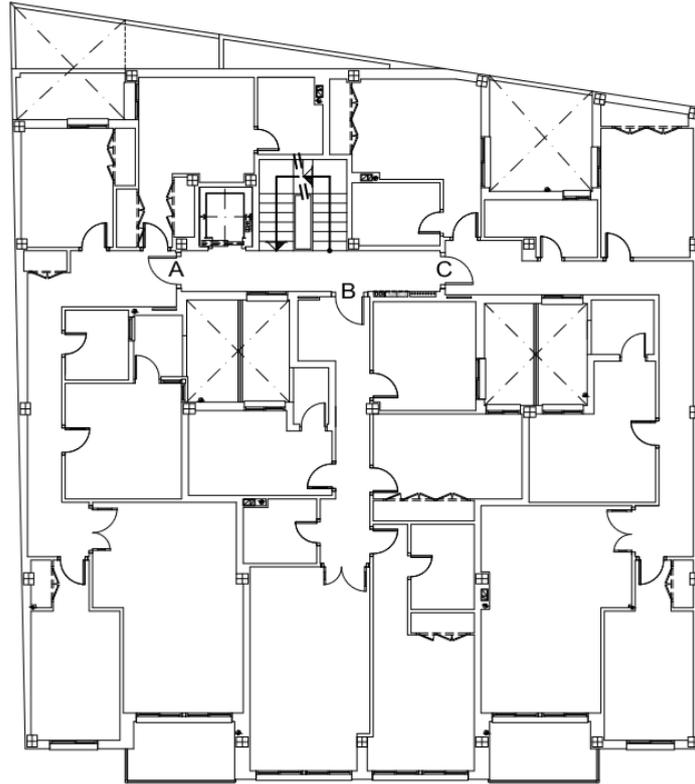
Planta Tipo Edificio Pla de l'Arc, 2010.
